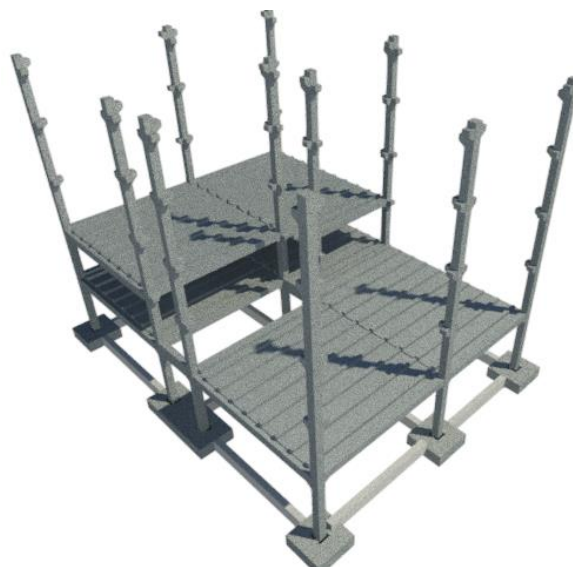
20. Secuencia constructiva del edificio prefabricado SLB
